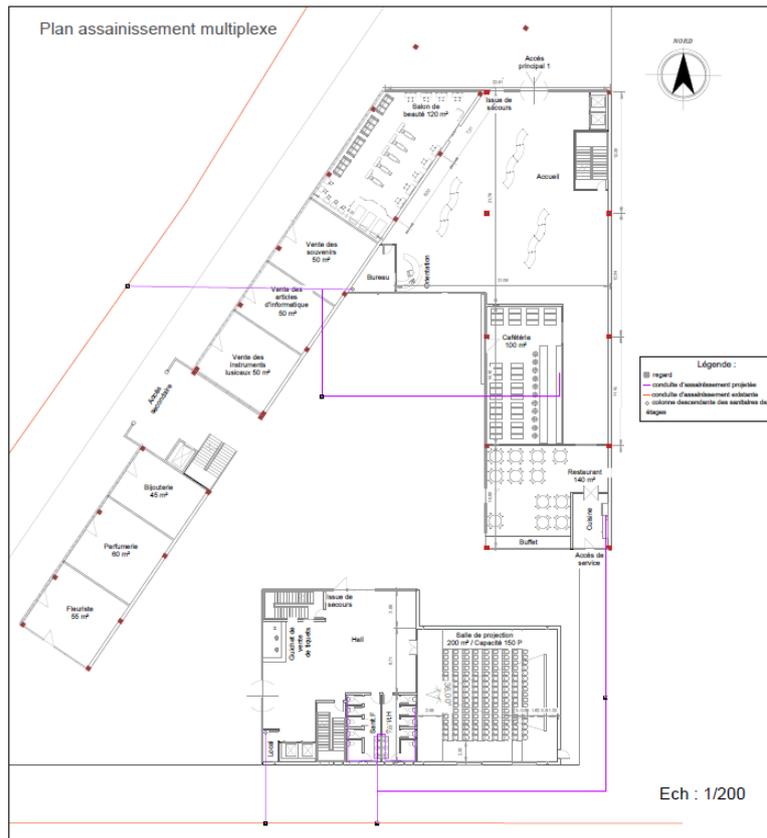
Plan d'assainissement du multiplexe ¹⁴⁷
